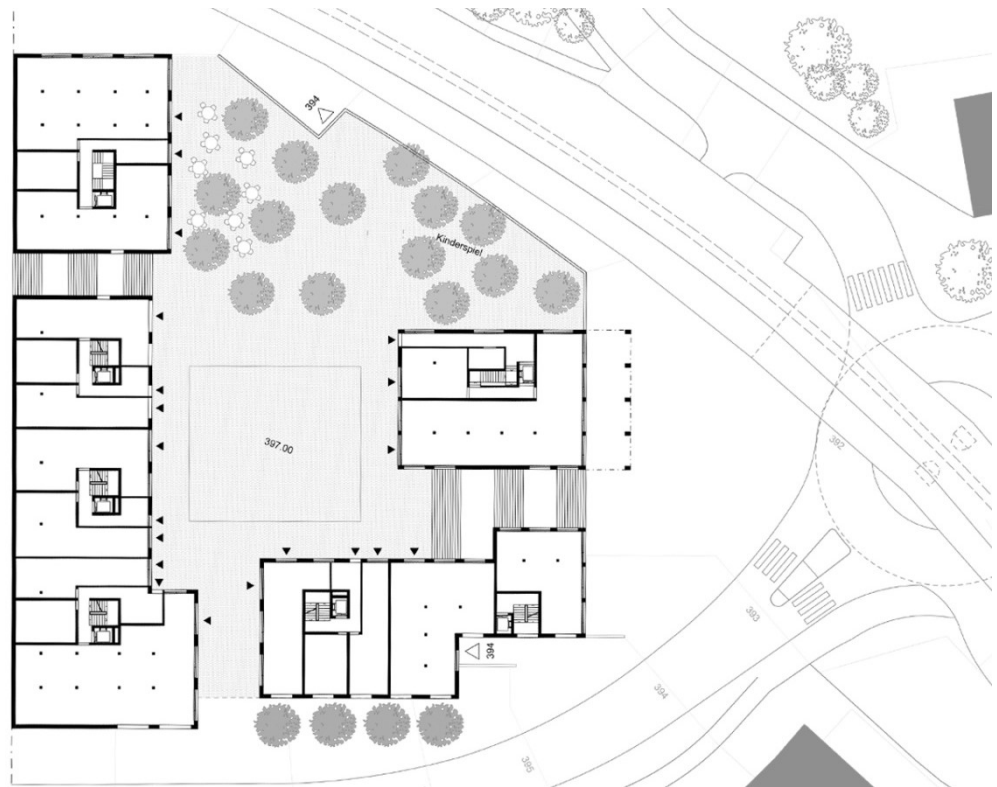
Grundriss EG (Hofgeschoss)
